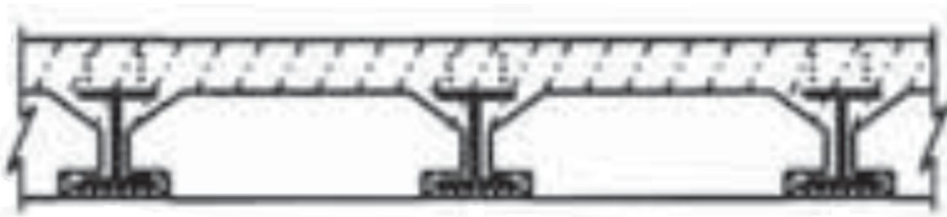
Фрагмент сборно-монолитного сталежелезобетонного перекрытия с жесткими стальными двутавровыми балками [65]
